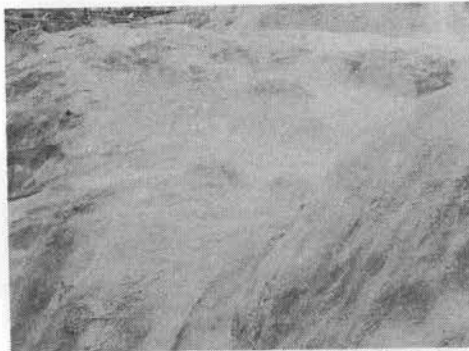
池原ダム洪水吐周辺斜面部仕上がり面
